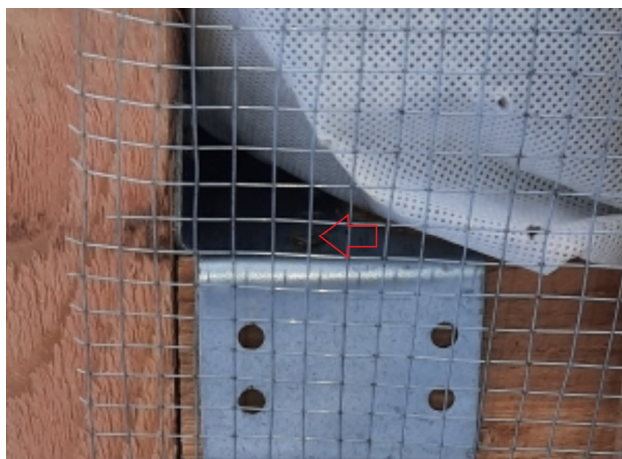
, 8 Крепление «черными» саморезами. Отсутствует гидроизоляционный слой.
